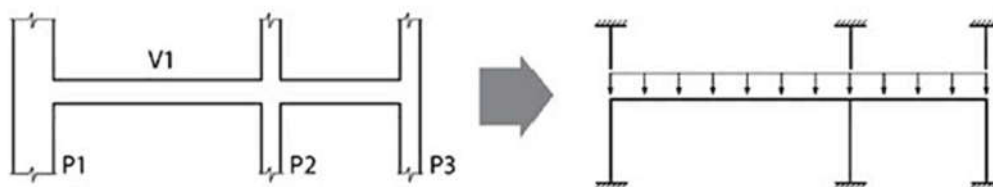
Modelo estruturas de vigas e pilares (KIMURA, 2007)
